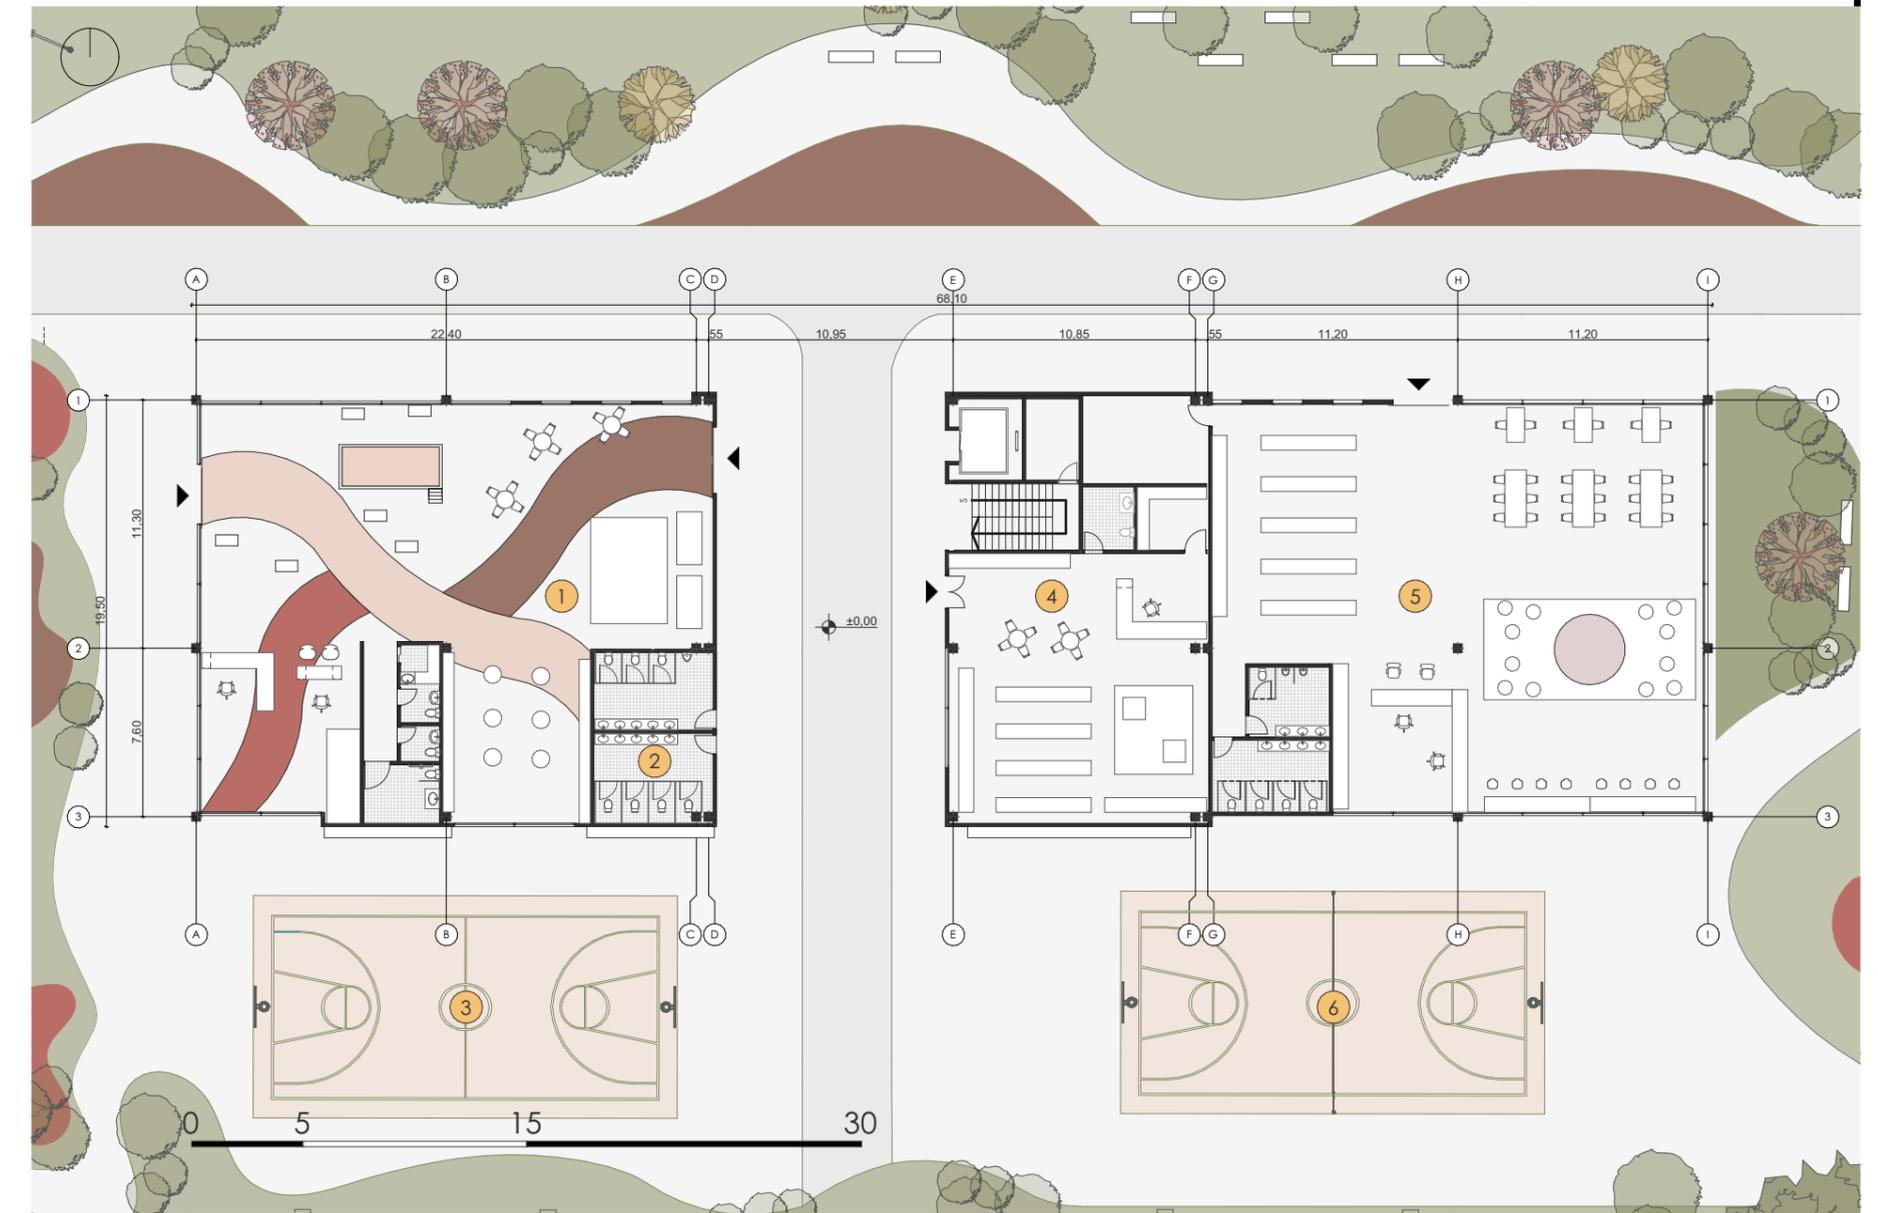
Planta baja bloque central Fuente: Propia, 2022
